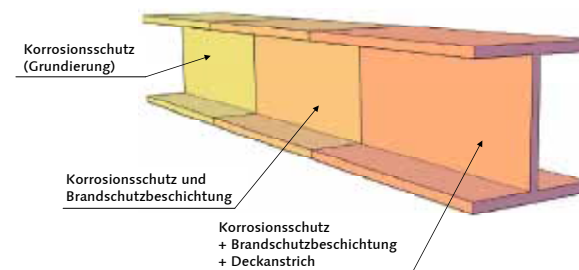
Aufbau einer dämmschichtbildenden Brandschutzbeschichtung
